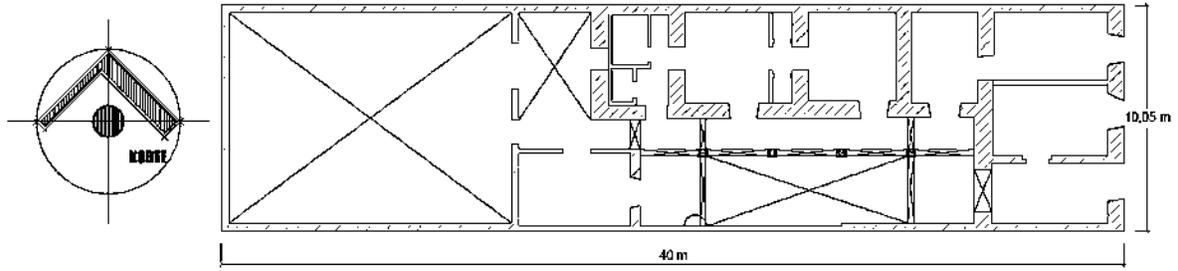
Distribución en planta del inmueble en estudio. Elaboración propia
